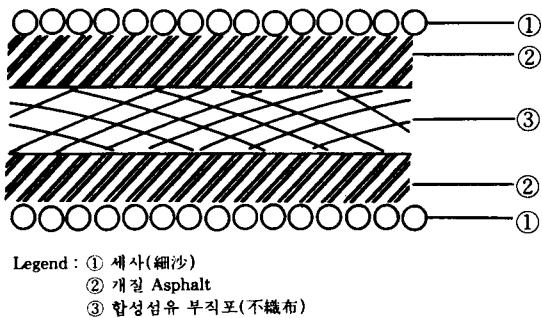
개질 Asphalt Roofing재의 단면도³⁾
